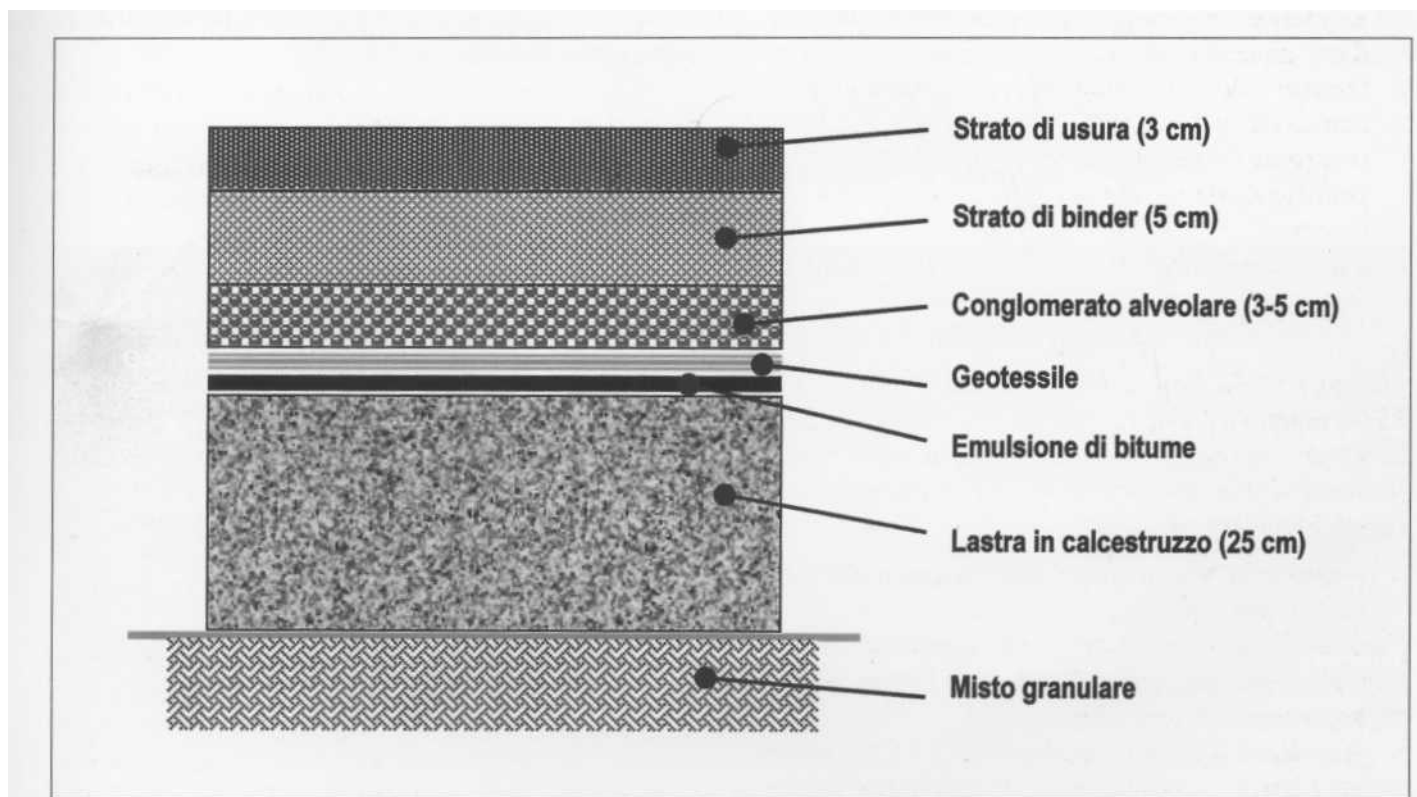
Sezione di pavimentazione con soluzione proposta "antirichiamo giunti"
